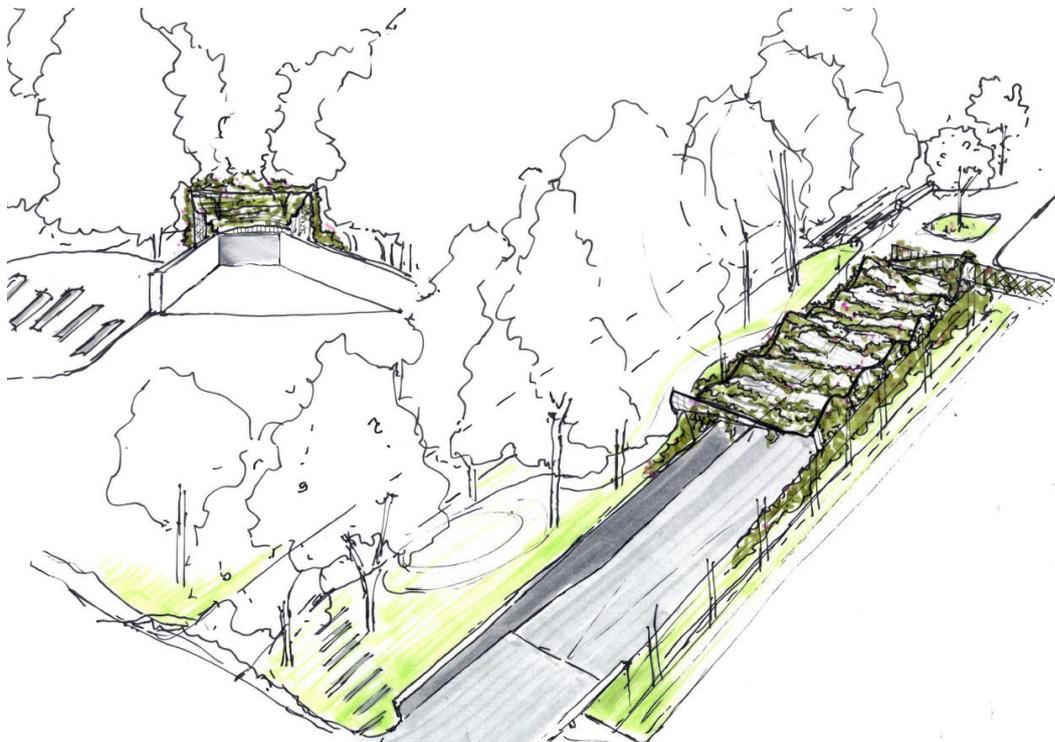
Planskizze der Tiefgaragenzufahrt mit Pergola, unmaßstäblich
